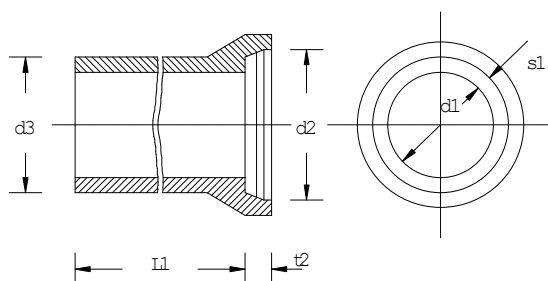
tubi in calcestruzzo di sezione circolare con manicotto senza piede
